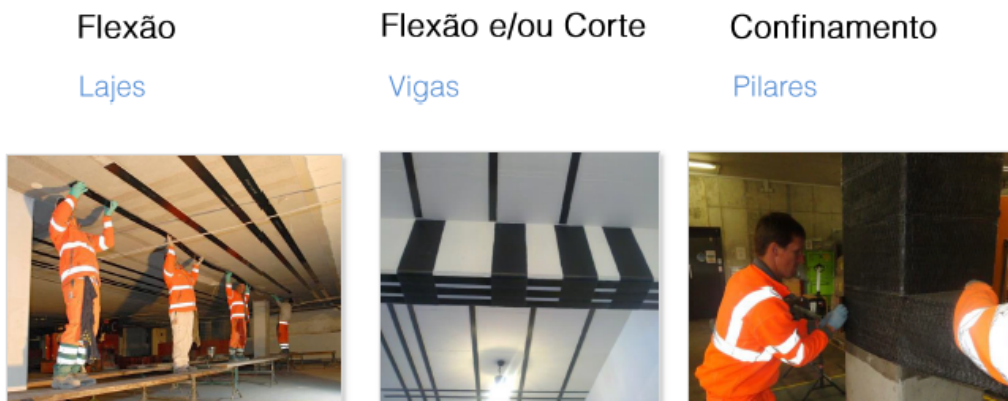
Aplicação de FRP na estrutura (Fonte: S&P apud Providência, 2021)
